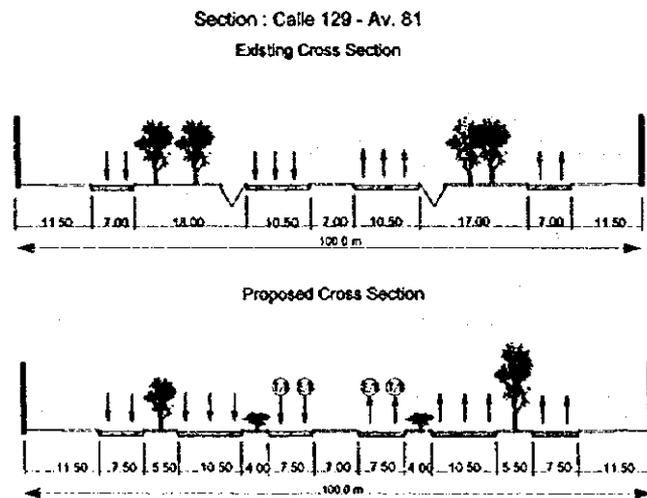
Sección Típica sobre Autopista Norte (3)
